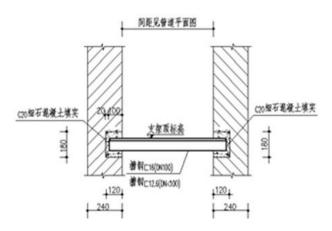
墙体为混凝土砌块时钢梁跨接方式
